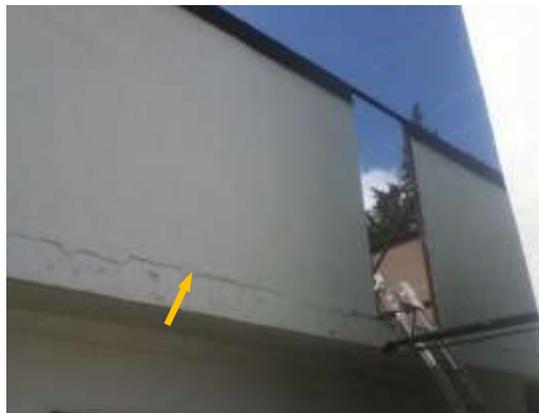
Fisura en la junta entre el faldón de durock y la losa de concreto. No es daño estructural, sólo estético.
